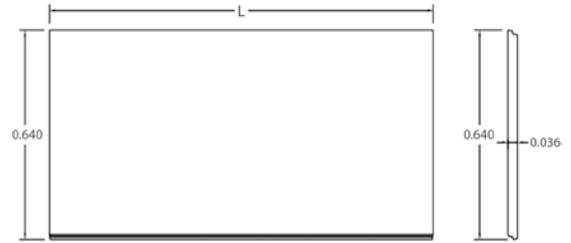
Vista longitudinal y sección transversal de una baldosa tipo estándar Prefa Holcim
